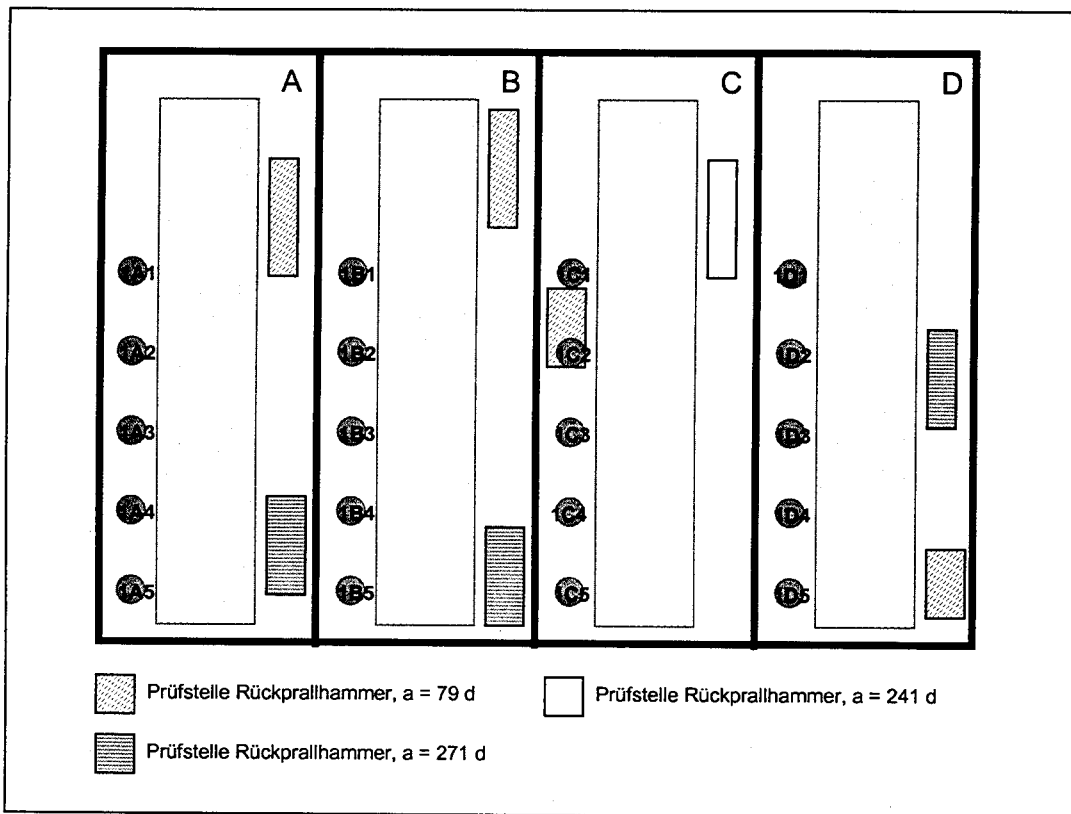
Lage der Prüfflächen am Betonkörper 1
